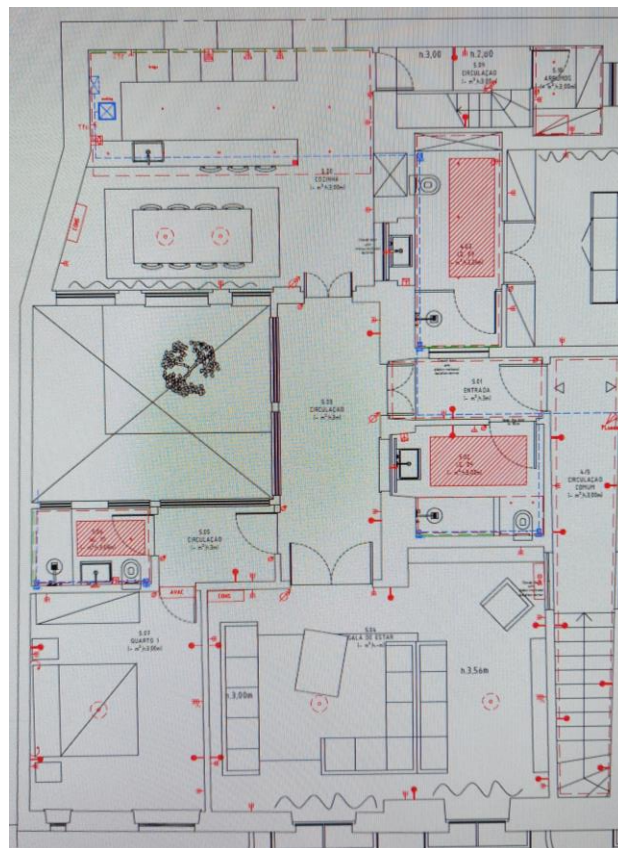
Planta de eletricidade. Fonte: Atelier Studio Arte
